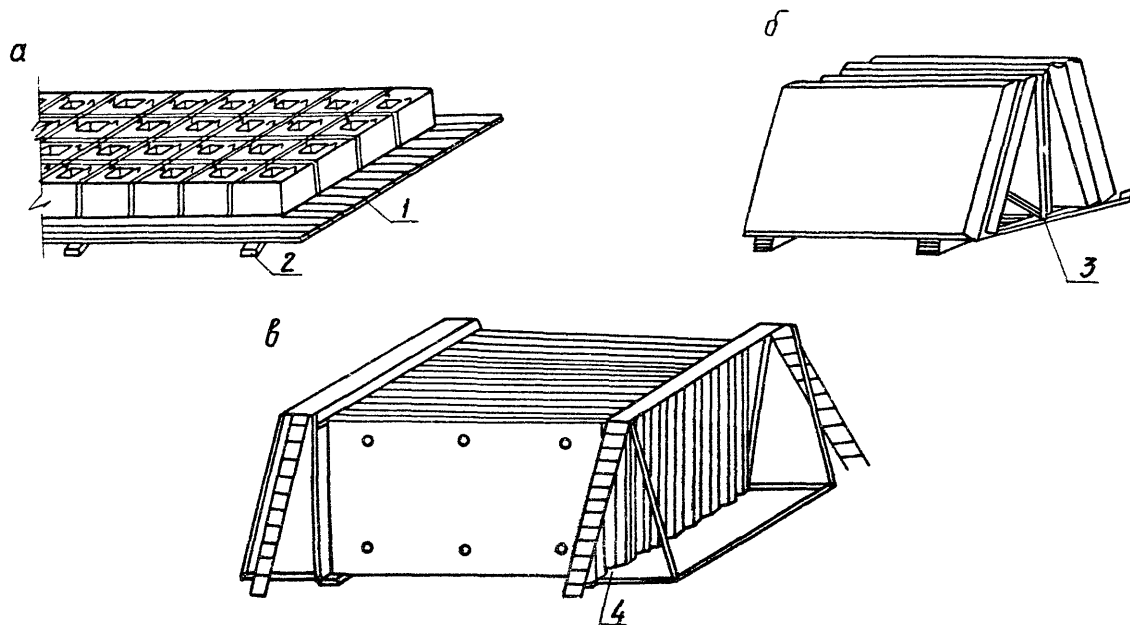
Смадрование сборных конструкций: а-оголовков; б-покольных панелей; в-панелей перекрытий; 1-настил из досок 40 мм; 2-подкладка 80x80 мм; 3-металлическая пирамида на 4 покольные панели; 4-кассета конструкции Гипрооргсельстроа
